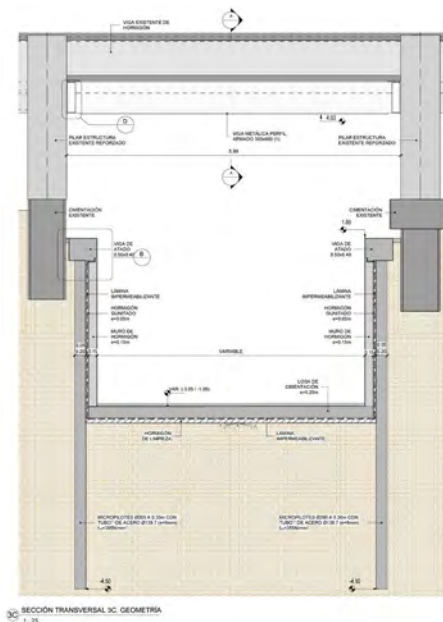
Sección transversal de proyecto del túnel de carros donde se aprecia la cota de las cimentaciones existentes y la nueva construcción a cota inferior. Procedente del proyecto de ejecución.
